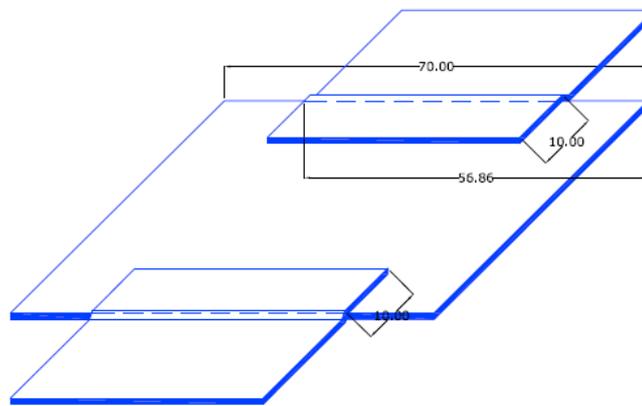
Exemple de joint plat surélevé, protection dalles sur plots – Cas du bicouche
